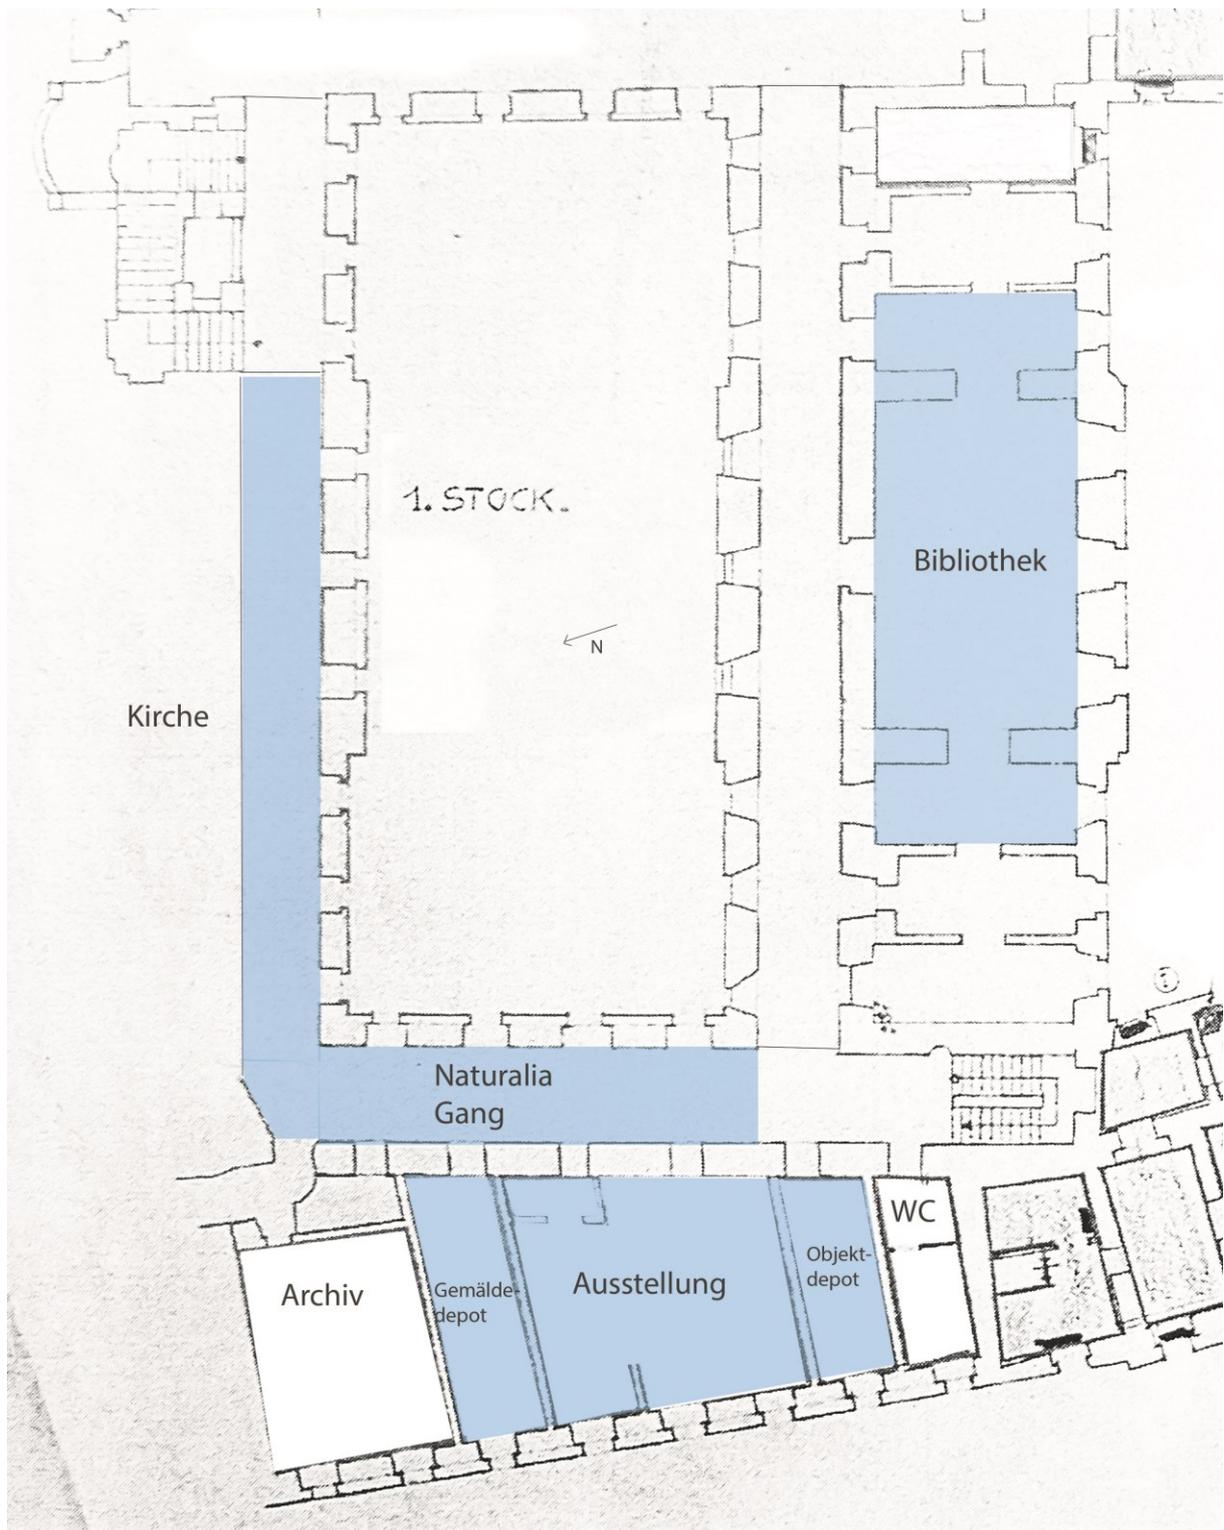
Grundrissplan des neuen Ausstellungsbereiches im ersten Stock des Stiftes
